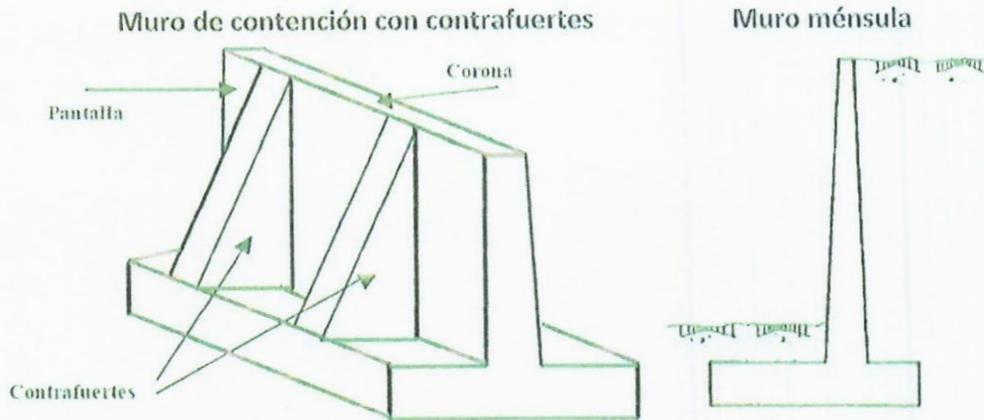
Ejemplo de un muro de contención con contrafuertes y un muro ménsula
